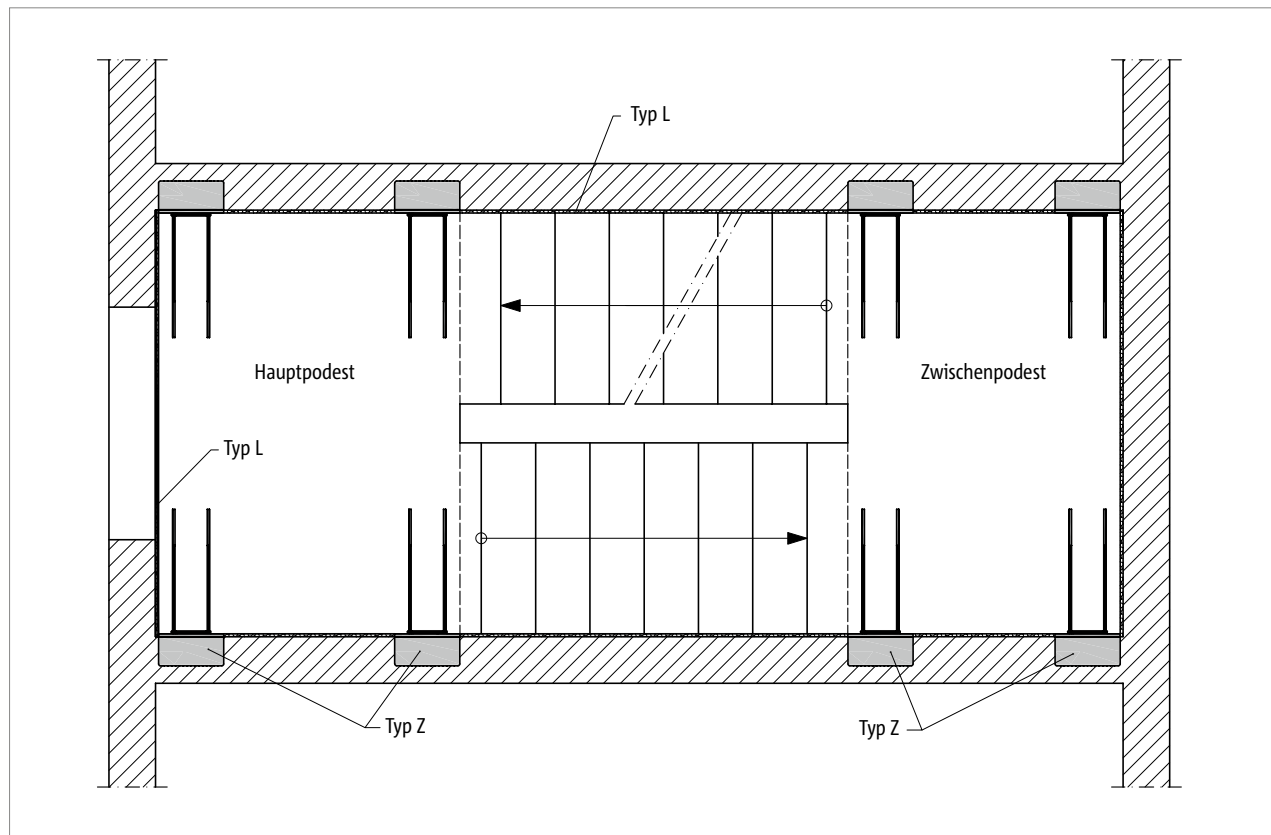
Tronsole® Z: Elementanordnung im Grundriss
